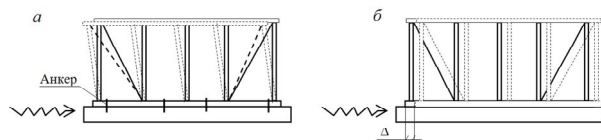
Деформирование здания из деревянного каркаса при сейсмическом воздействии: *а* - соединение нижнего пояса каркаса с цоколем здания анкерами; *б* - соединение нижнего пояса каркаса с цоколем здания без анкеров
